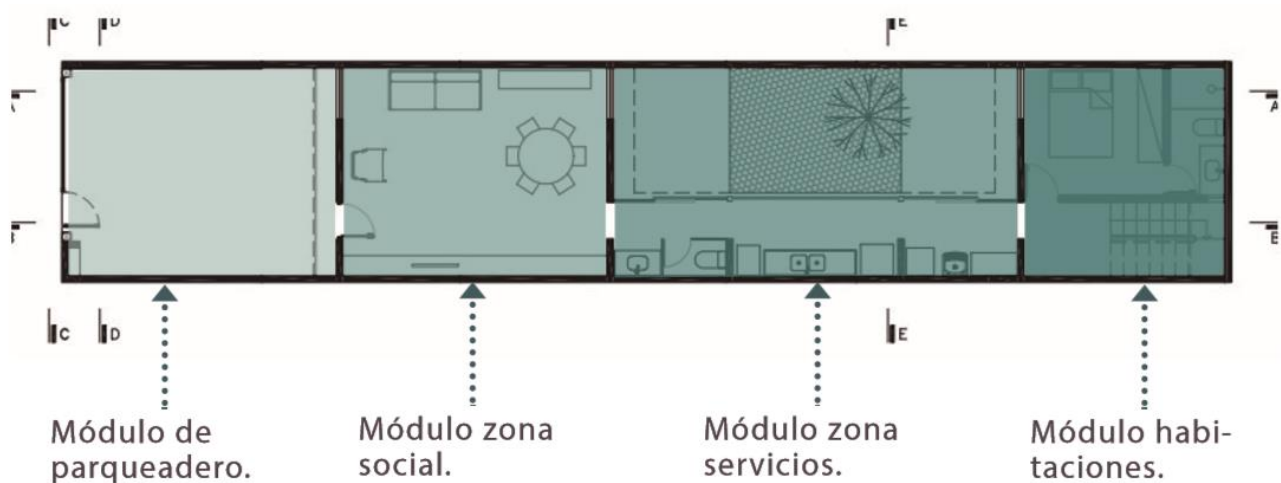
PLANTA PRIMER PISO VIVIENDA VILA MATILDE EN SAO PAULO, BRASIL.
